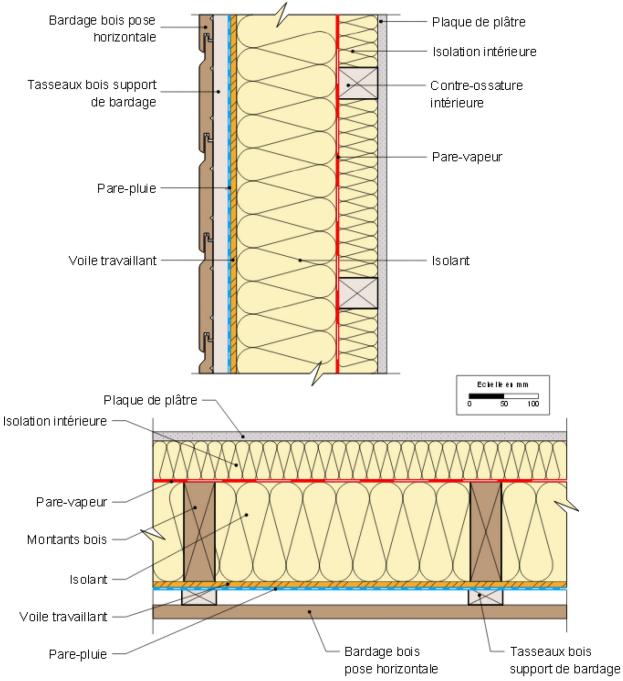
Doublage isolant par l'intérieur (coupe verticale en haut, verticale en bas)
